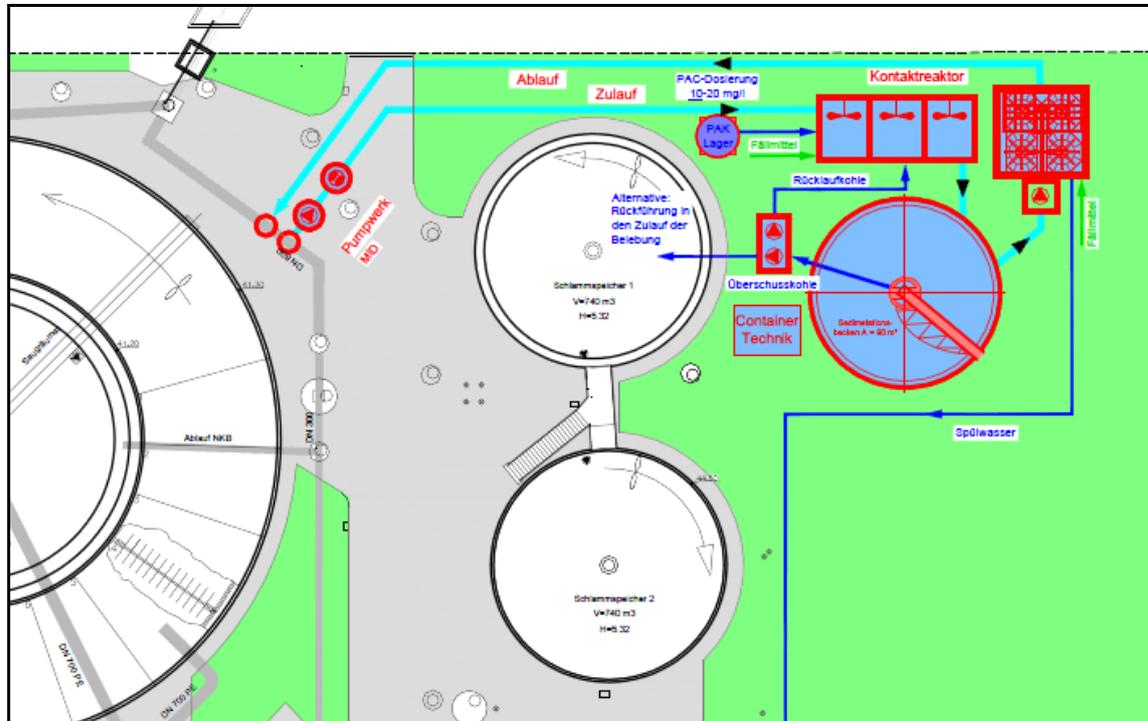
Lageplan KA Rahden - Variante 1.2 – PAK Dosierung in adsorptive Reinigungsstufe
